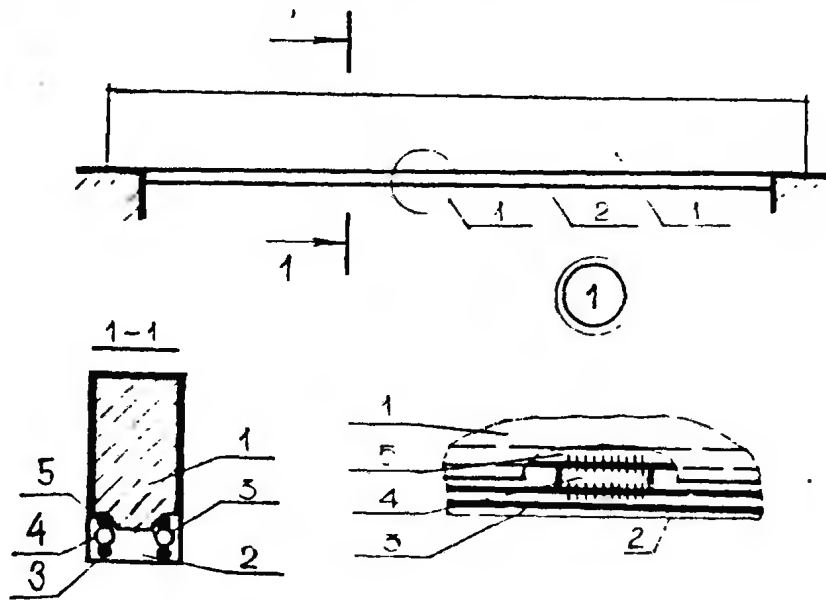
Нарощування балок знизу при незначному збільшенні їхньої несучої здатності: 1 – посилювана балка; 2 – залізобетонне нарощування; 3 – поздовжня арматура посилення; 4 – арматурні коротиші; 5 – оголена арматура (ділянки із кроком через 1,0 м)
